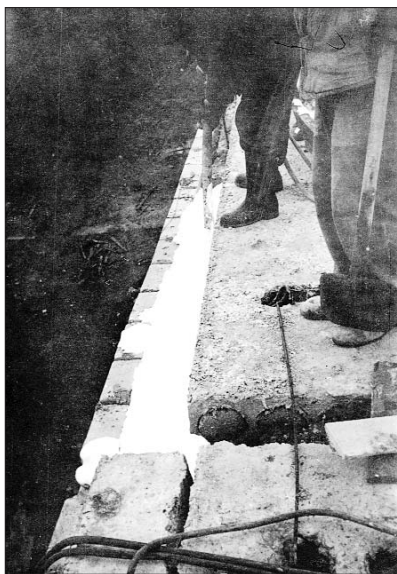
Заливка утеплителем МФП-2 облегченной кирпичной наружной стены пятиэтажного жилого дома в Электростали 1973 г. [9]
